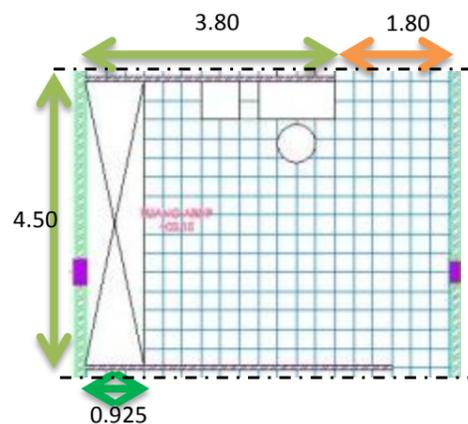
Ruang-ruang servis lantai 2 Asuransi ABDA
